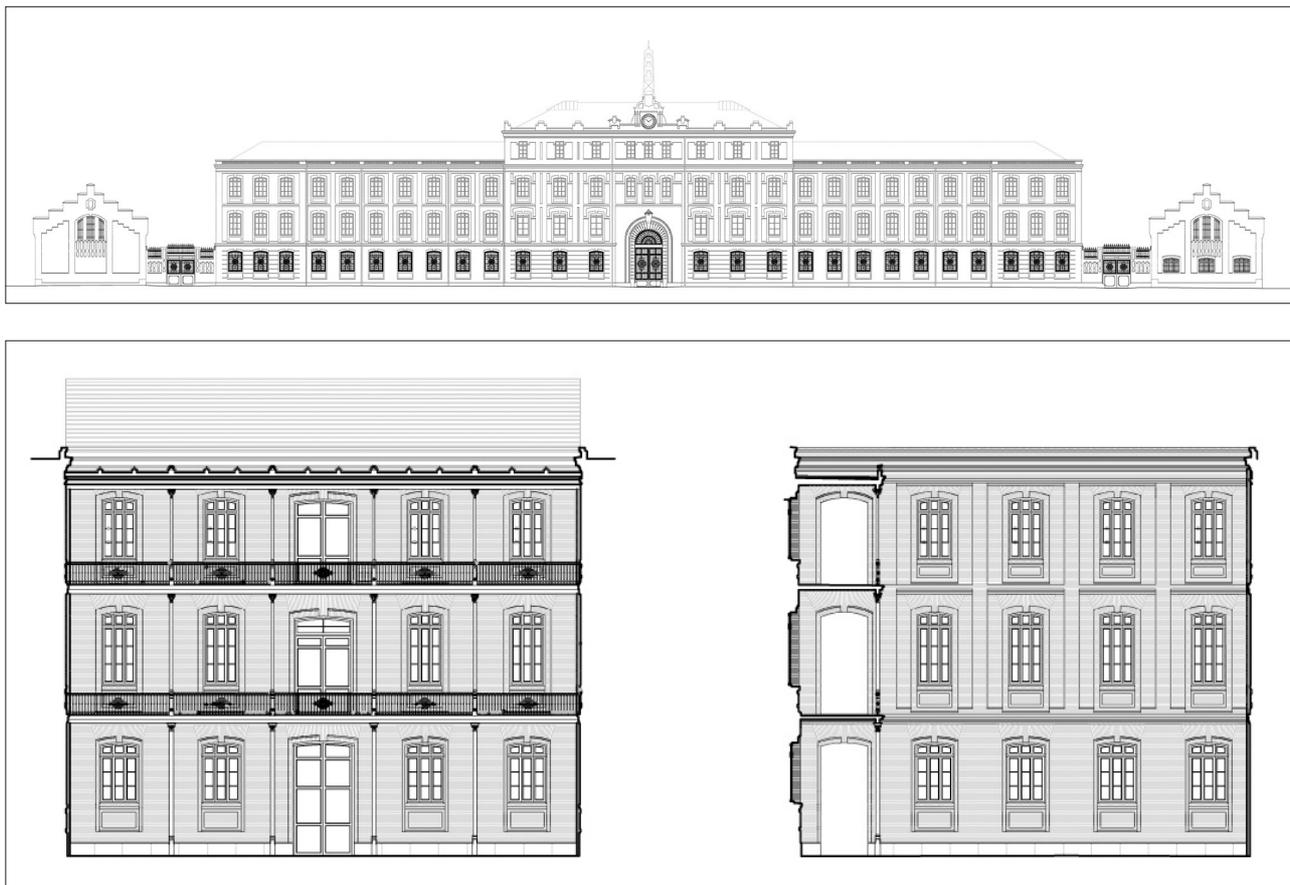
Arriba la Fachada principal en su estado "ideal", abajo las fachadas norte y este del patio situado al norte en el cuerpo central
